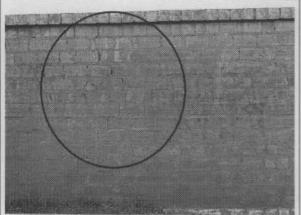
Agrietamientos y fisuras desde el exterior del lote.
